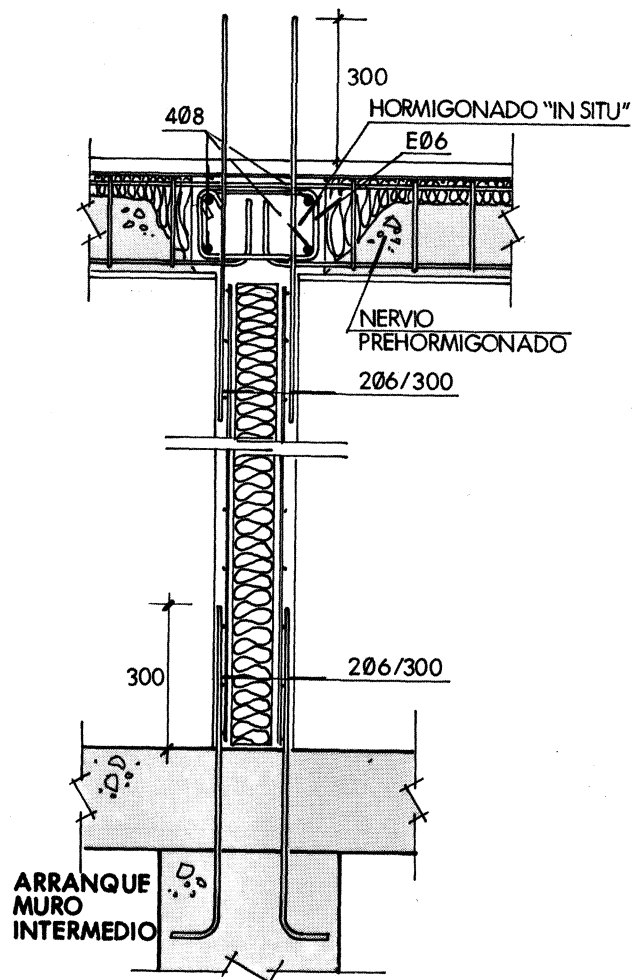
Detalle constructivo de muro D-P I intermedio en arranque e intersección con forjado.
